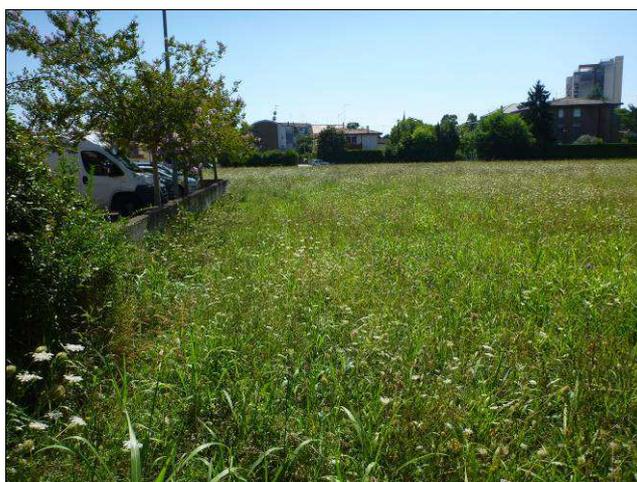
Stato attuale area di intervento; vista in direzione sud-ovest.
